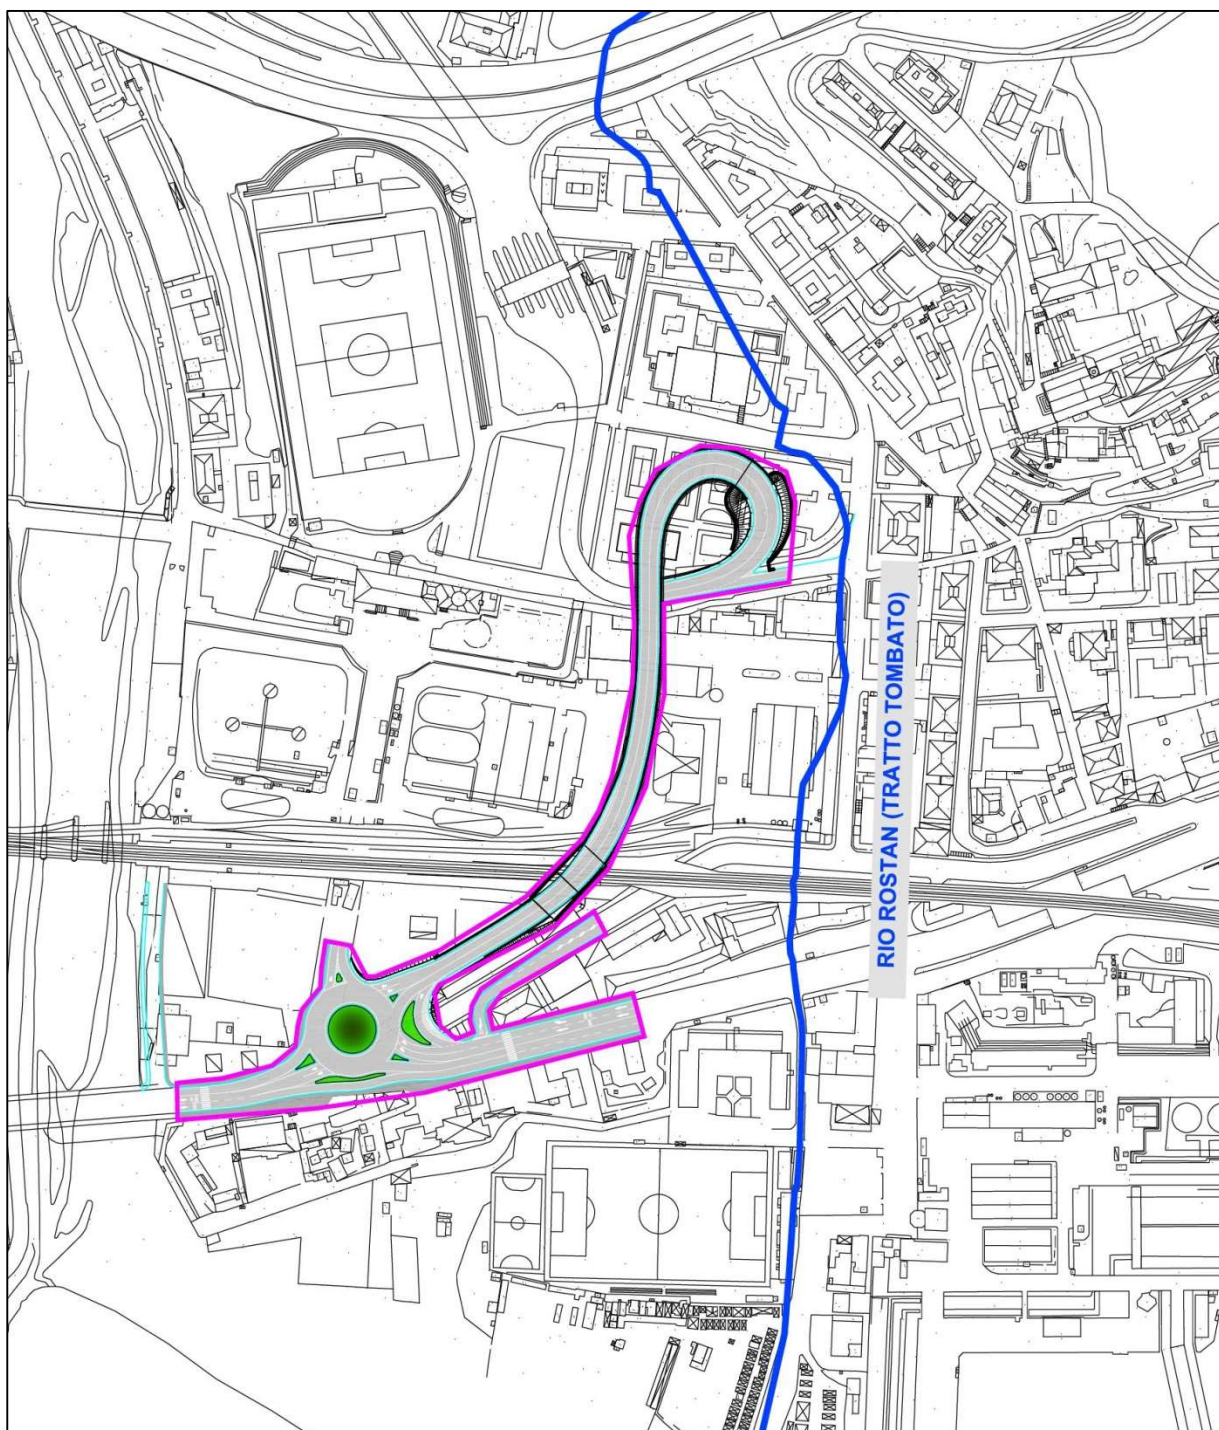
Rio Rostan – Ubicazione rispetto a intervento in progetto
